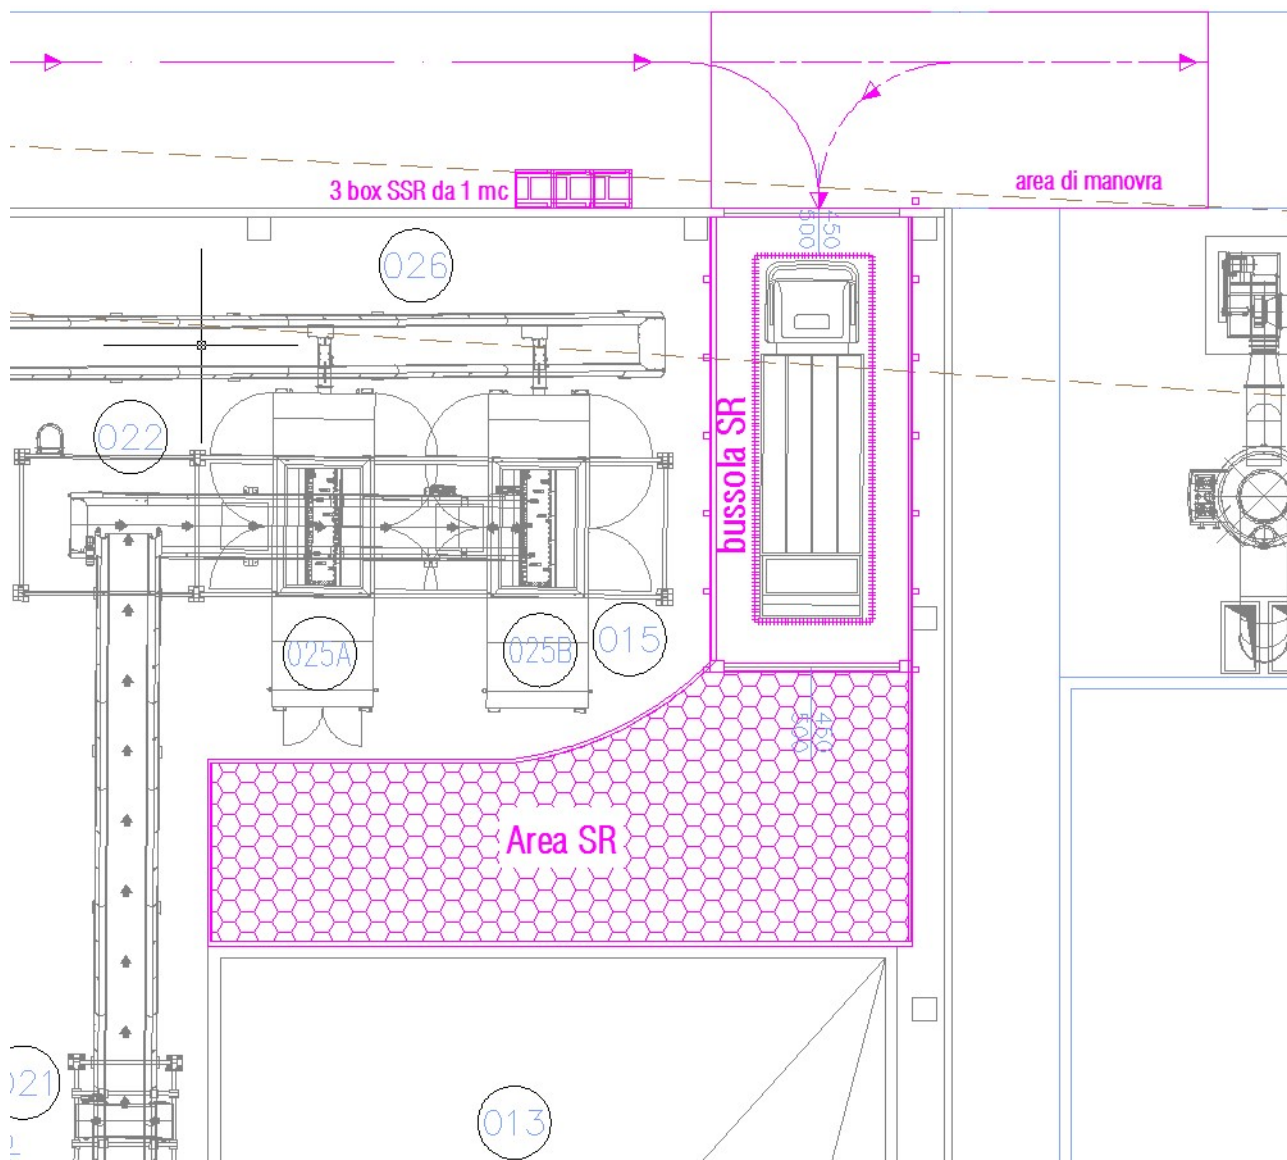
Planimetria "Area SR" / 013 Fossa accettazione rifiuti / 015 Capannone A
